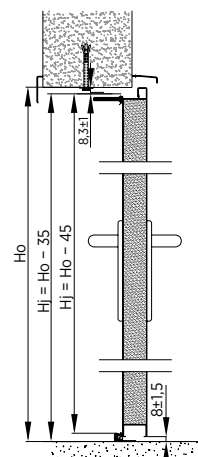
Montage mural d'un bloc-porte à un battant avec bâti enveloppant - coupe verticale
